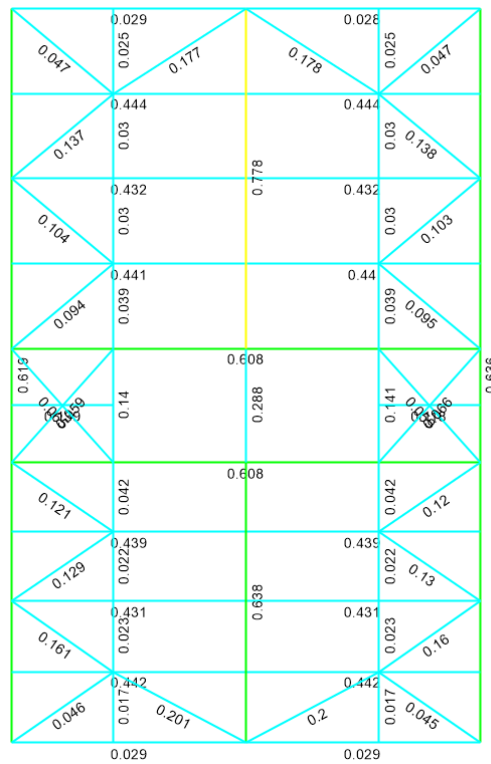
Factores de utilización planta quinto nivel para cargas de diseño LRFD.
